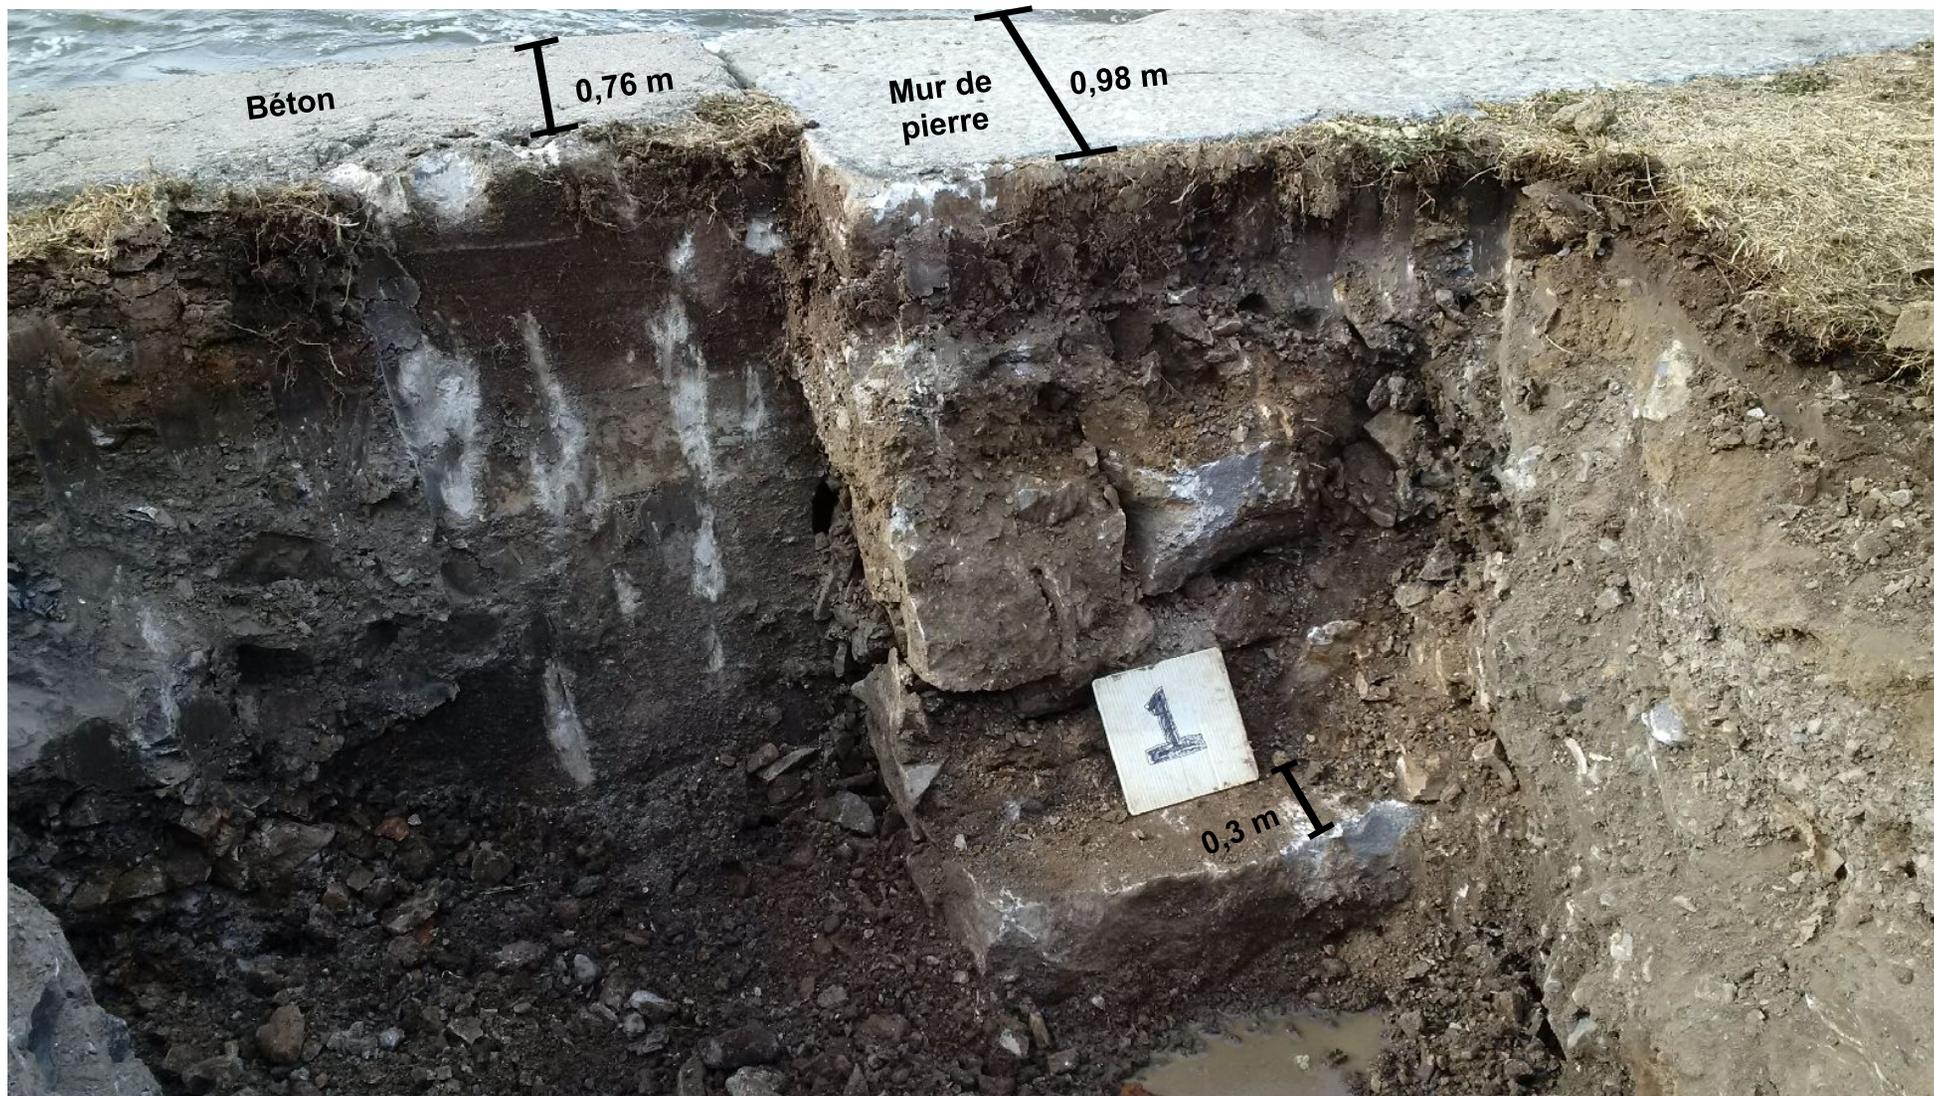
Tranchée no TR-01 - Jonction du mur en béton et en blocs de pierre
